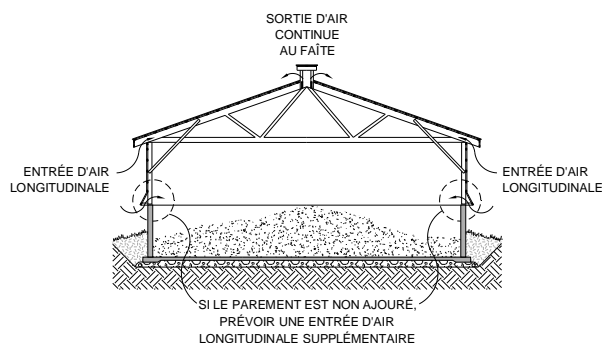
Coupe transversale d'un ouvrage de stockage couvert bien ventilé.
